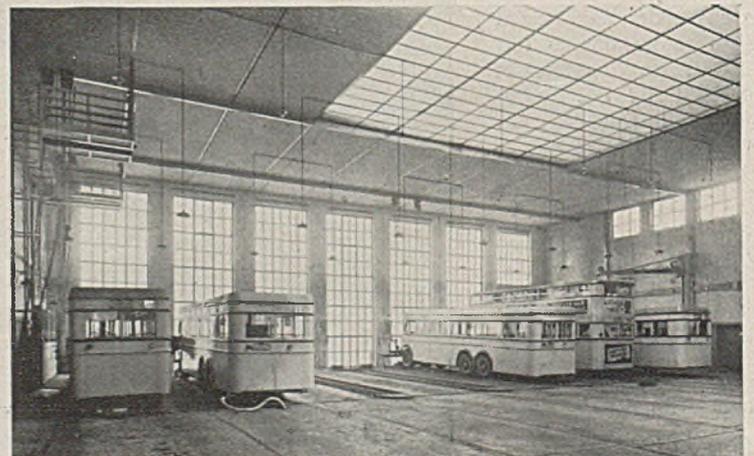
Halle II. Reparaturstände mit Krananlagen.
